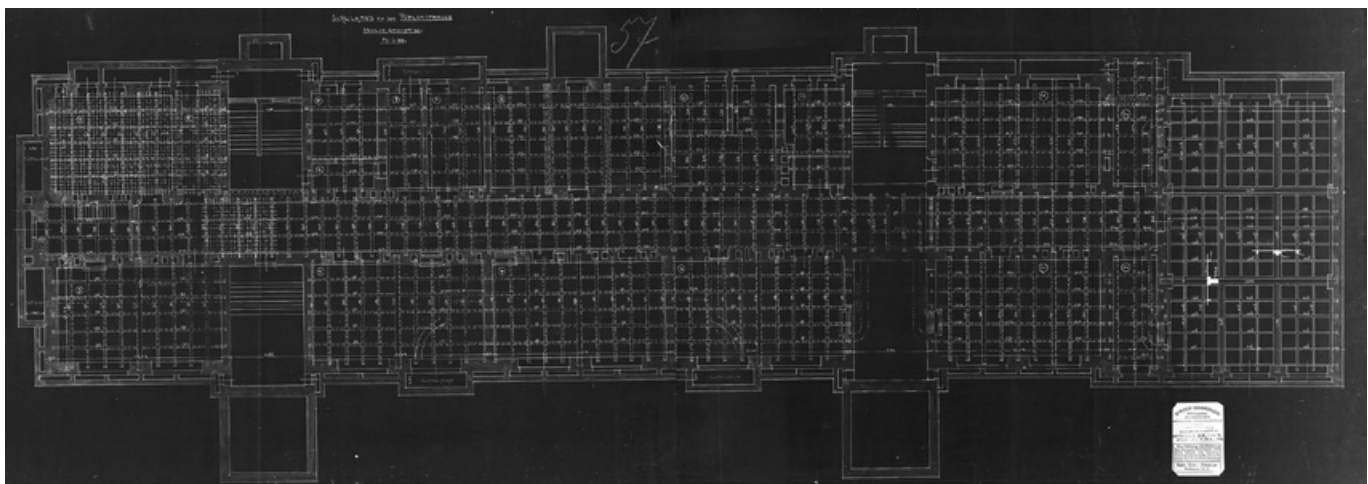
Bewehrungsplan einer Decke nach System Hennebique mit Systemstempel (Bauref., Akt-Nr. 159).
